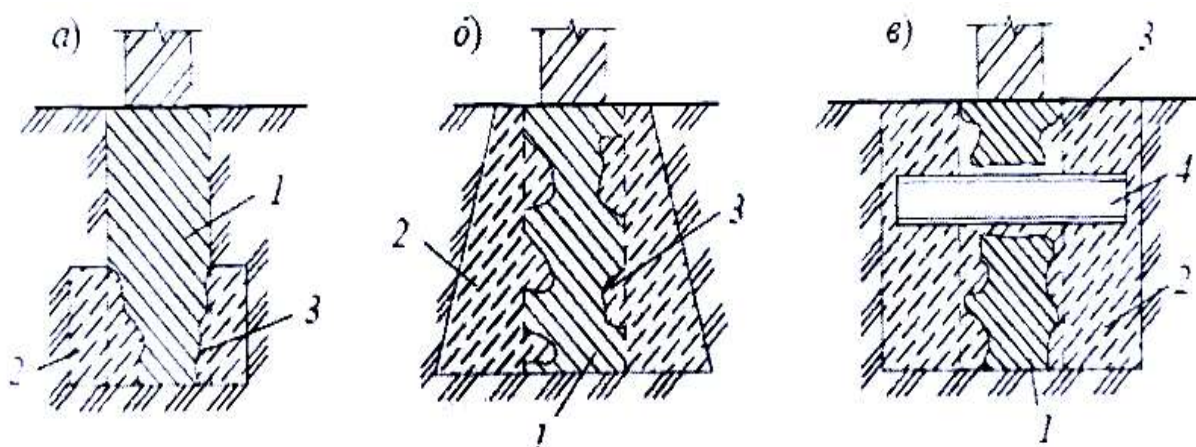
Схемы усиления ленточных фундаментов бетонными обоймами:
